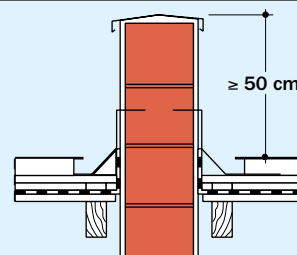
Brandwände im Dachbereich – Industriebau; Auszug aus: Bayerische Versicherungskammer München, Brandwände und Öffnungen in Brandwänden, Anforderungen und Ausführung
